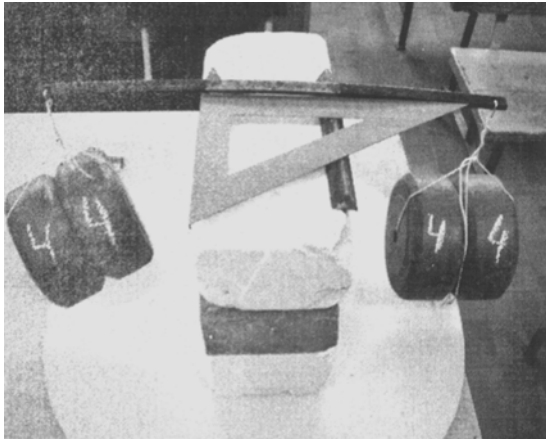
Общий вид образца в процессе испытания под нагрузкой 8 кг
